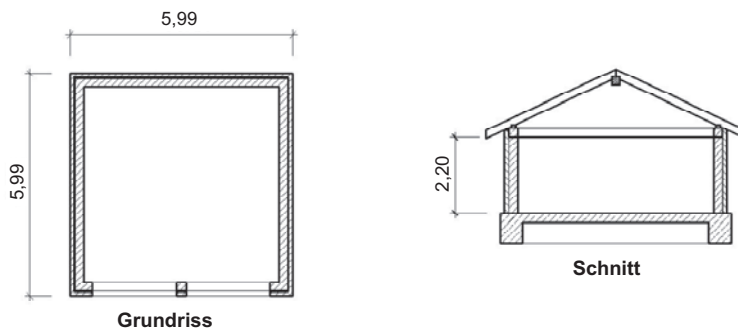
Beispiel Doppelgarage: Grundriss und Schnitt
